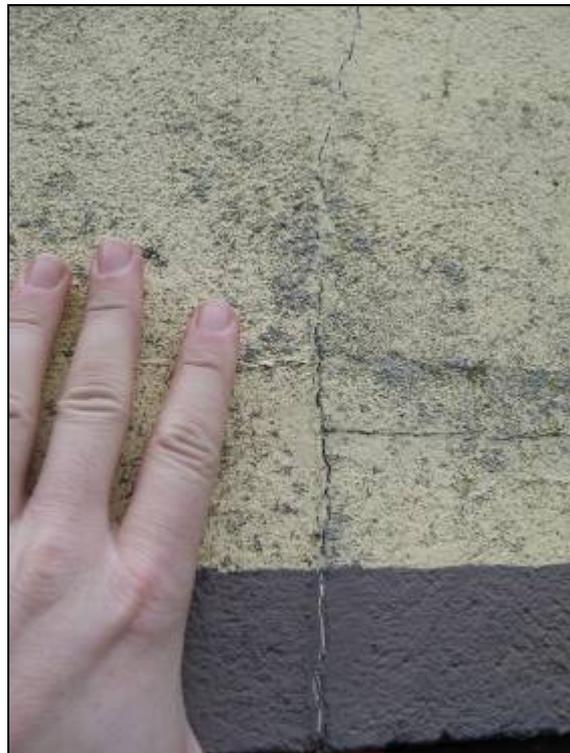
Fissure sur le bâtiment du côté est jouxtant la terrasse, derrière la maison de M. Sahling.
